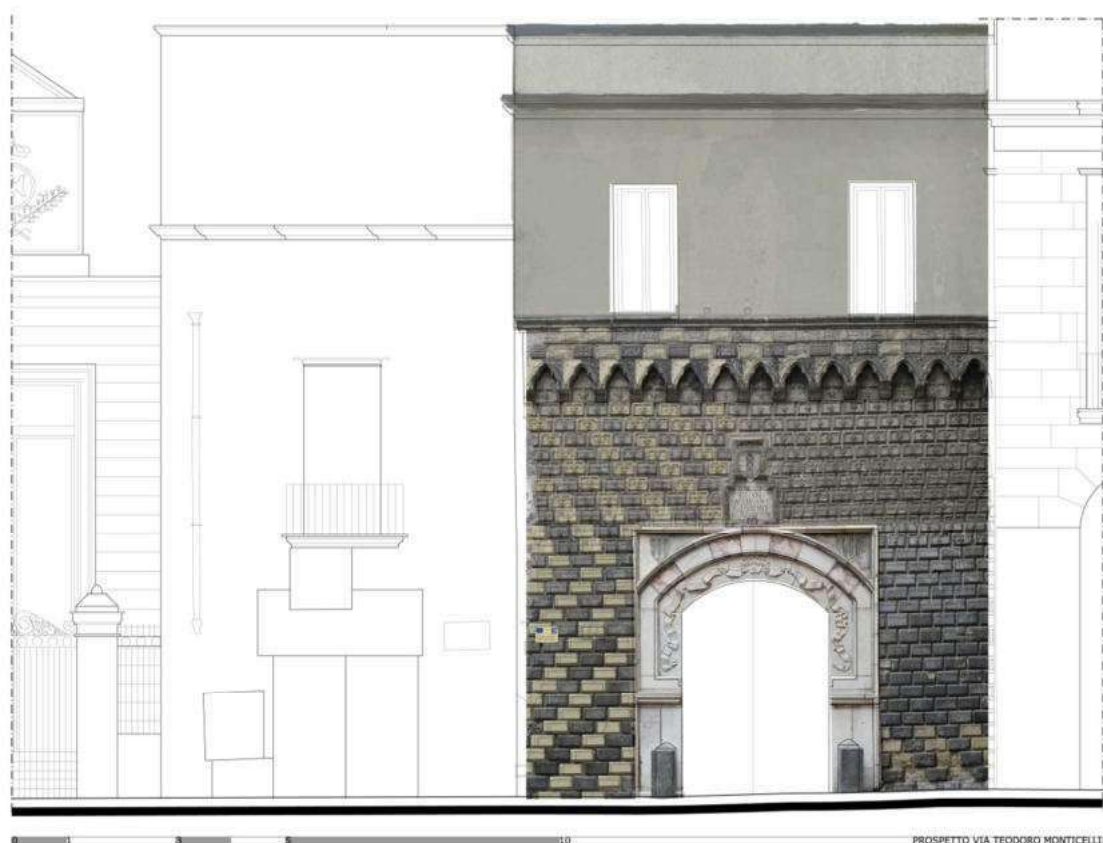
Prospetto su via Teodoro Monticelli. Simulazione del possibile esito del progetto di conservazione delle superfici
